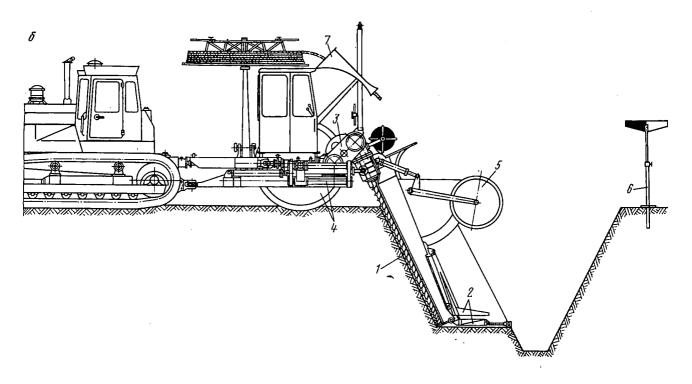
Машина МЭД-1 для дренировання торфяной залежи: t — рабочий аппарат (винтовая фреза); 2 — трубоформователь; 3 — редуктор; 4 — шасси; 5 — закрывающий аппарат; 6 — визирное приспособление; 7 — механизм трубки
